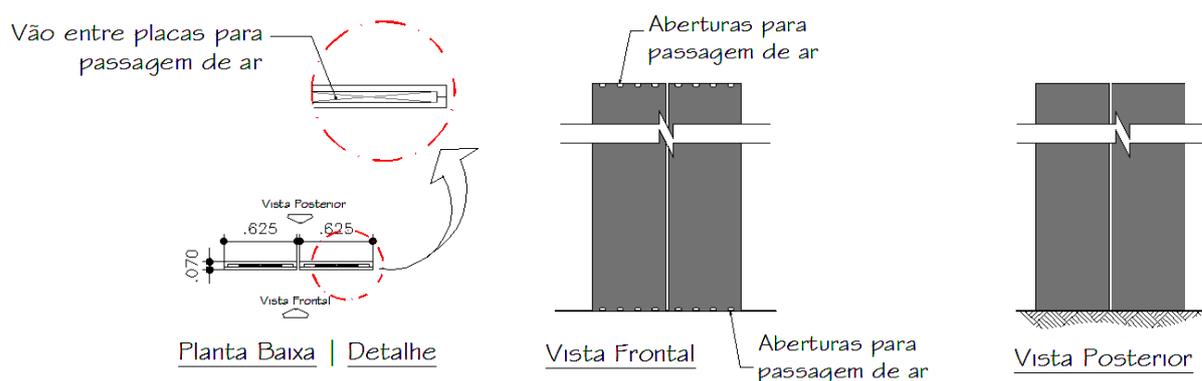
Parede Externa - Planta Baixa com Detalhe e Vista Frontal e Posterior.
